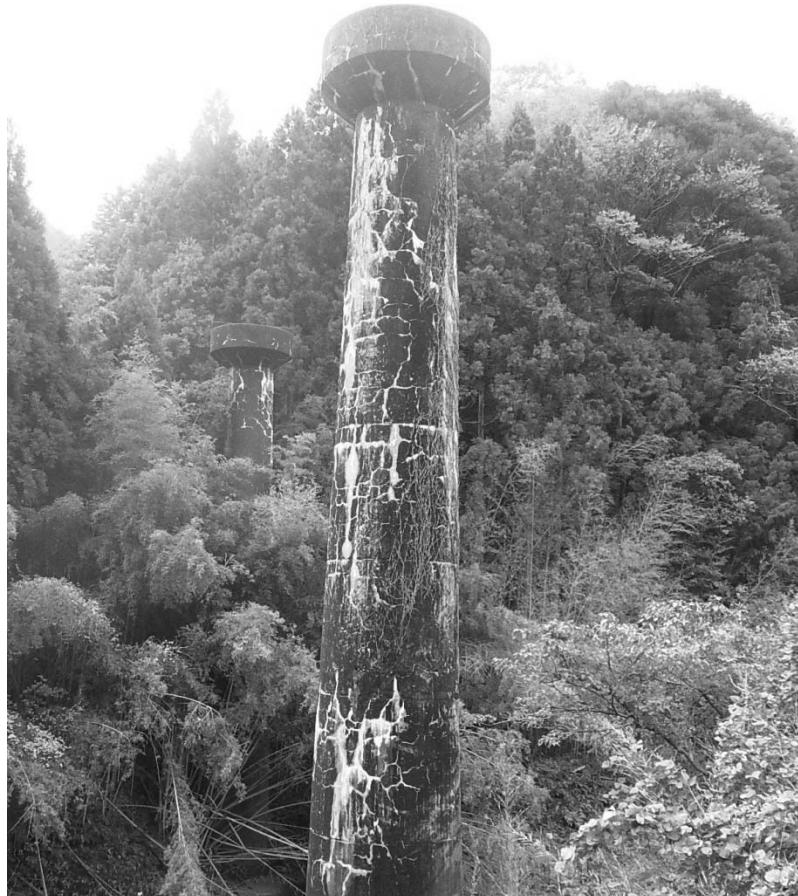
宇津井地区橋脚群に見られるひび割れ
